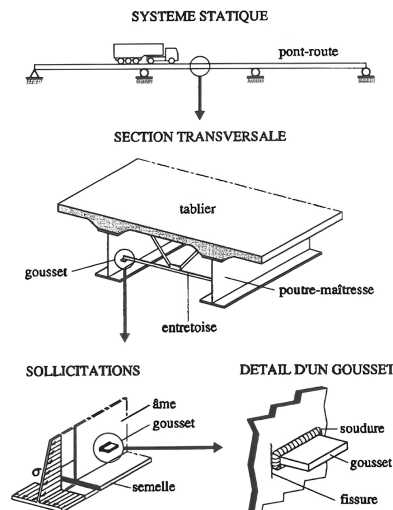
Localisation possible d'une fissure de fatigue dans un pont poutre [17].
